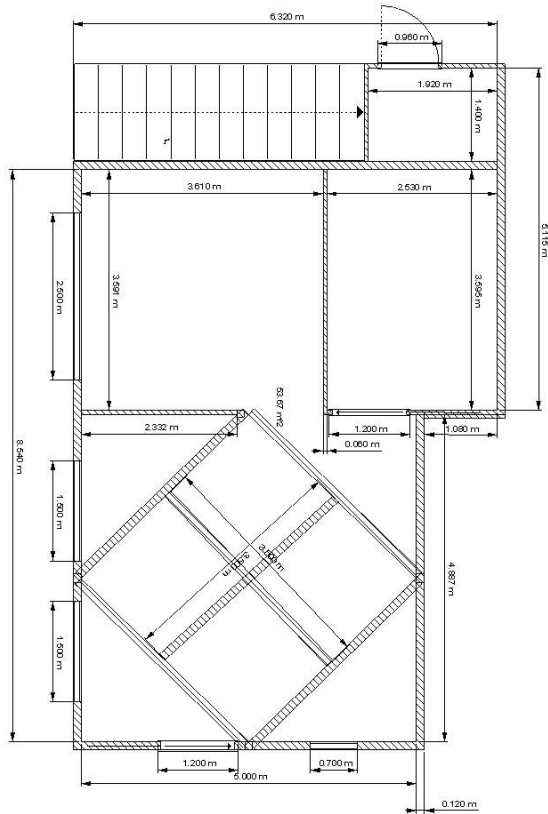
Plano en planta de metalTIC – Hogar Digital
